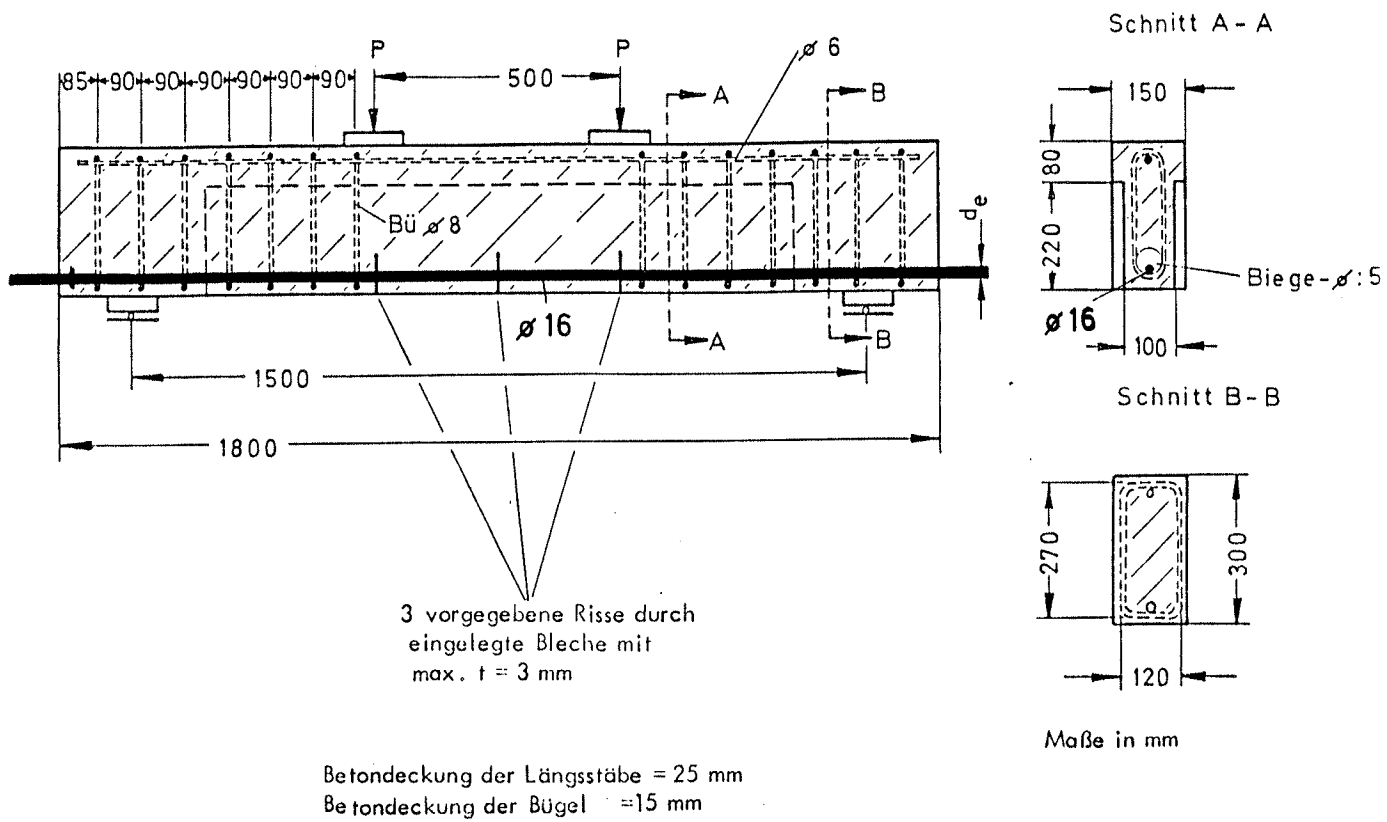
BALKENARTIGE VERSUCHSKÖRPER FÜR DIE PRÜFUNG VON GERADEN, EINBETONIERTE BETONSTÄHLEN
